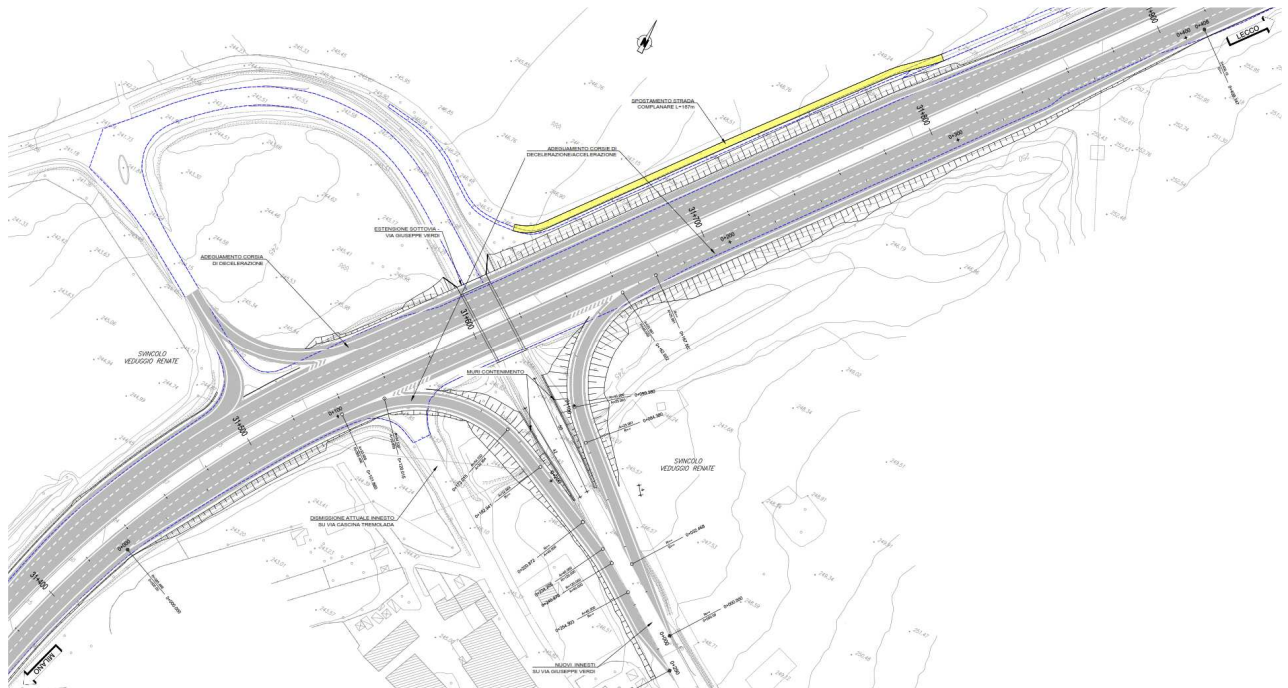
Planimetria di Progetto Svincolo di Veduggio con Colzano
